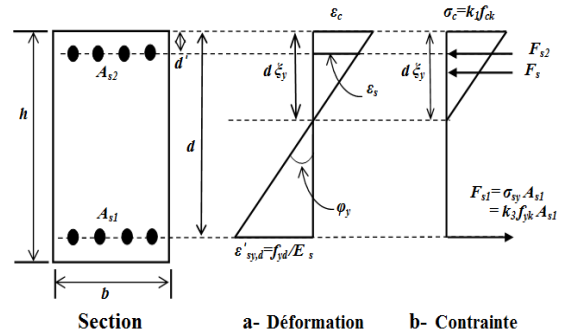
Comportement d'une section fléchie d'une poutre en béton armé à l'état limite de service.
